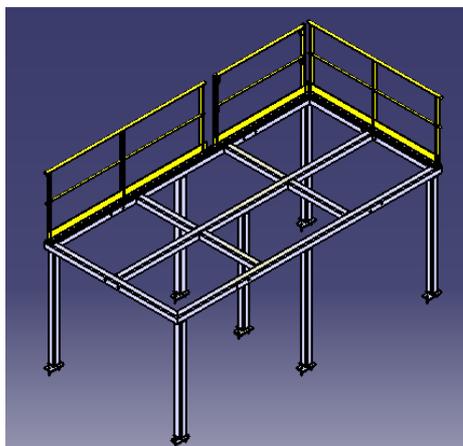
Paso 1 de cada módulo de la plataforma soldada.
